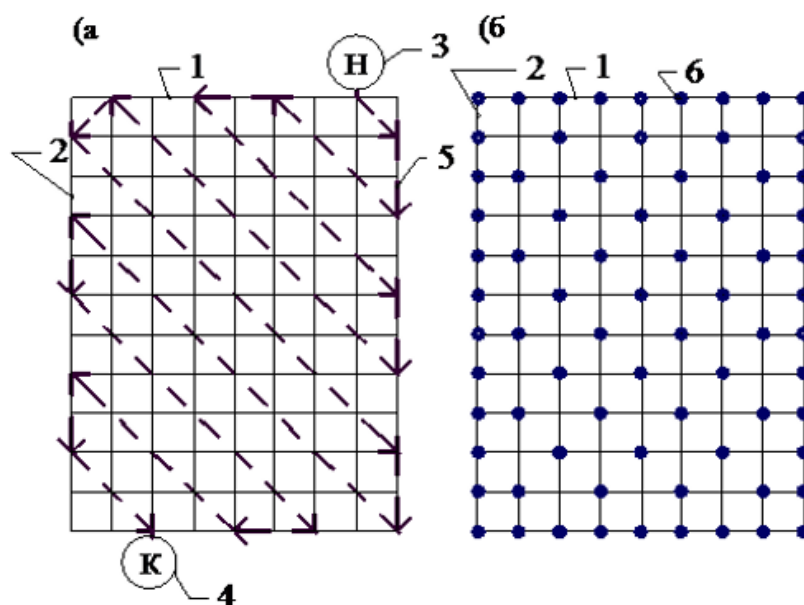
Порядок закрепления арматурных стержней вязальной проволокой:
